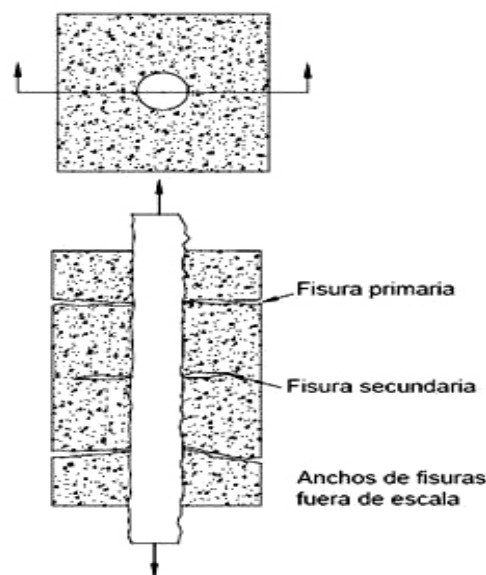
Fisuras primarias y secundarias en un elemento traccionado (ACI 224.2R, 2004)
